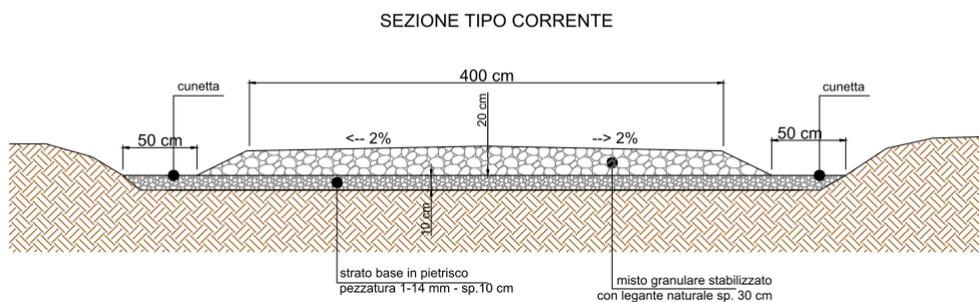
Sezione tipo strada principale di accesso (estratto di PRO_TAV_15)
